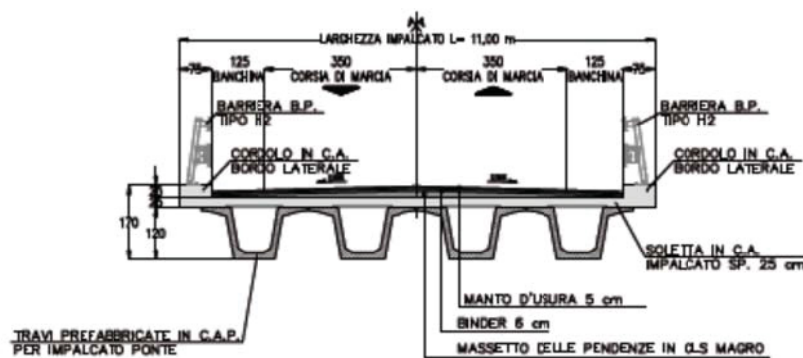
Sezione tipo opere in corrispondenza dell'attraversamento del fosso Paganico
